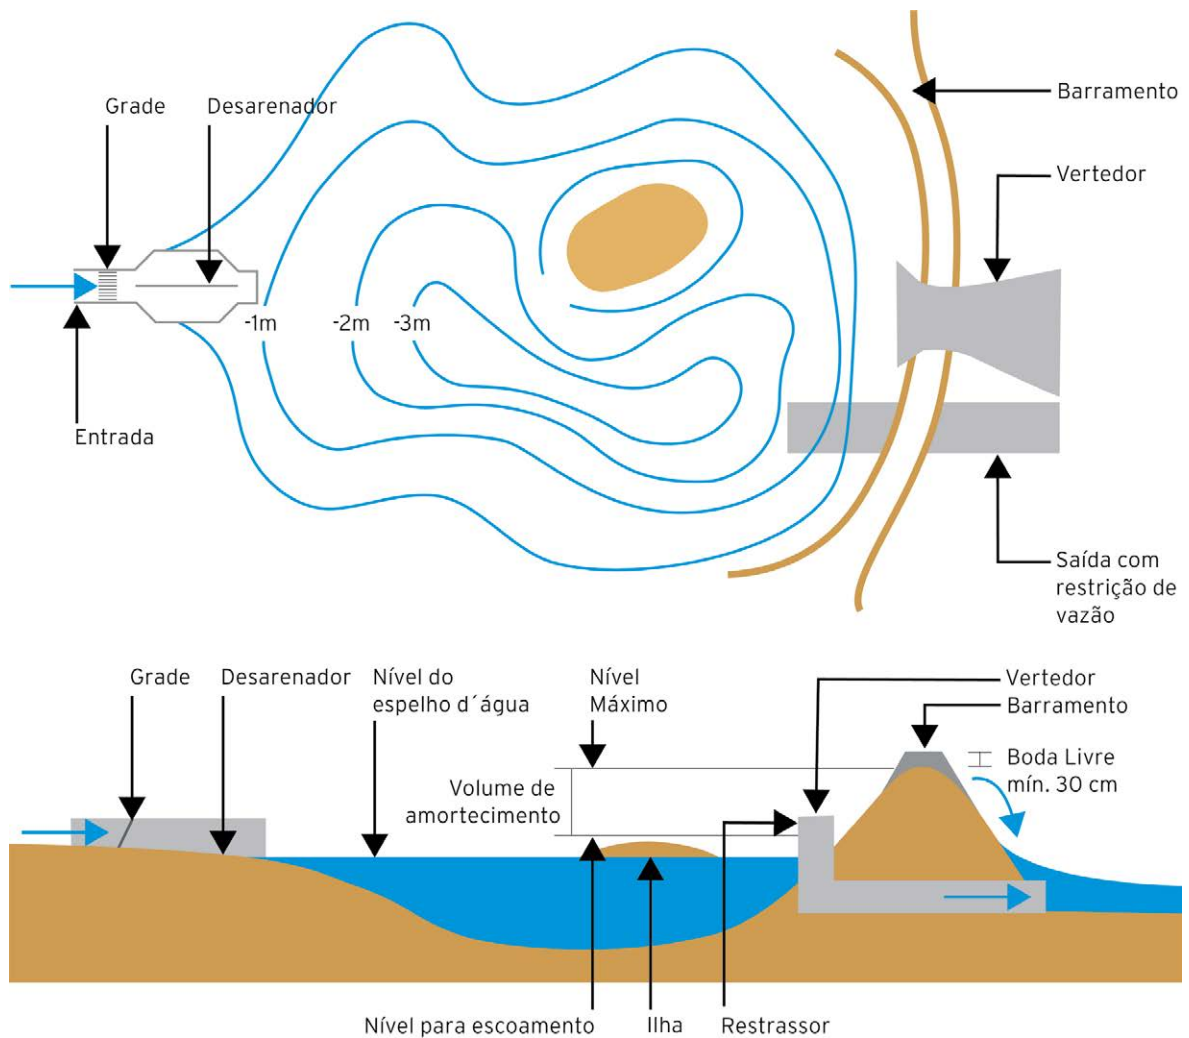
Planta e perfil longitudinal de um reservatório de retenção típico.
